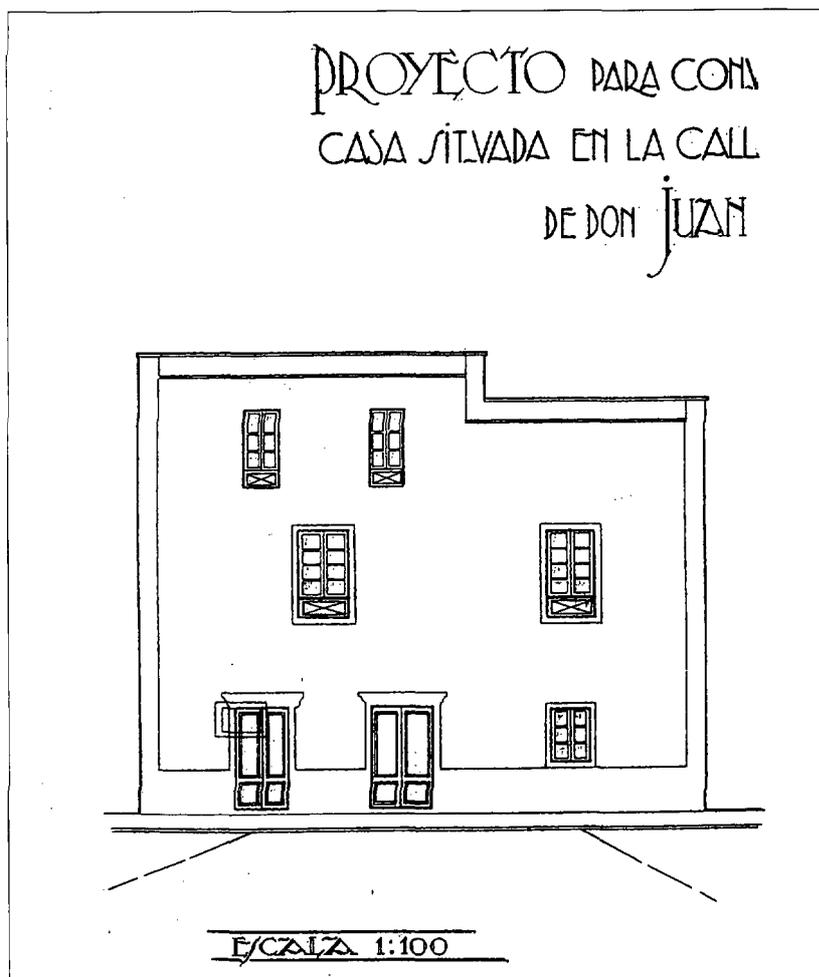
E. LAFORET: Fachada Casa n.º 7. C/ Colón. Plano del A.H.P.L.P.
